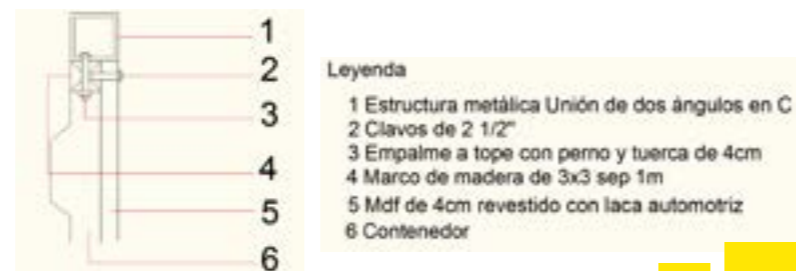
Detalle constructivo. Vista en corte lateral del recubrimiento para las paredes.
